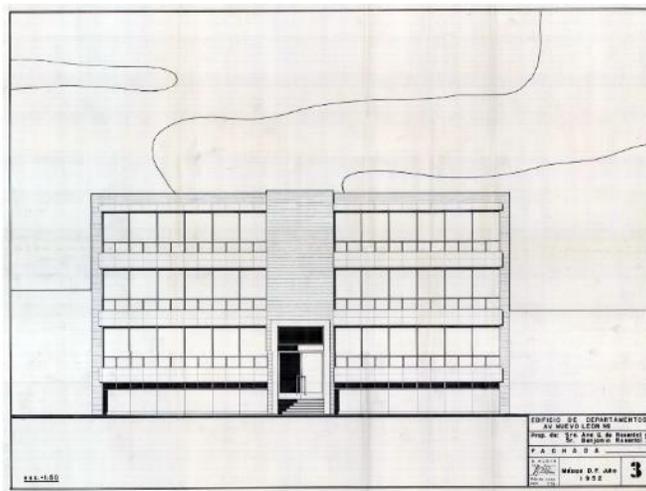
Plano de la fachada del proyecto del edificio ubicado en Nuevo León núm. 240, julio 1952
